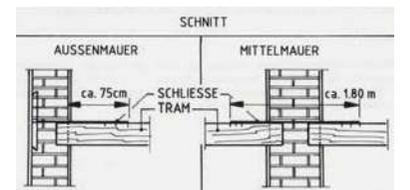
Detail, Auflager der Holzdecke auf tragenden Wänden
